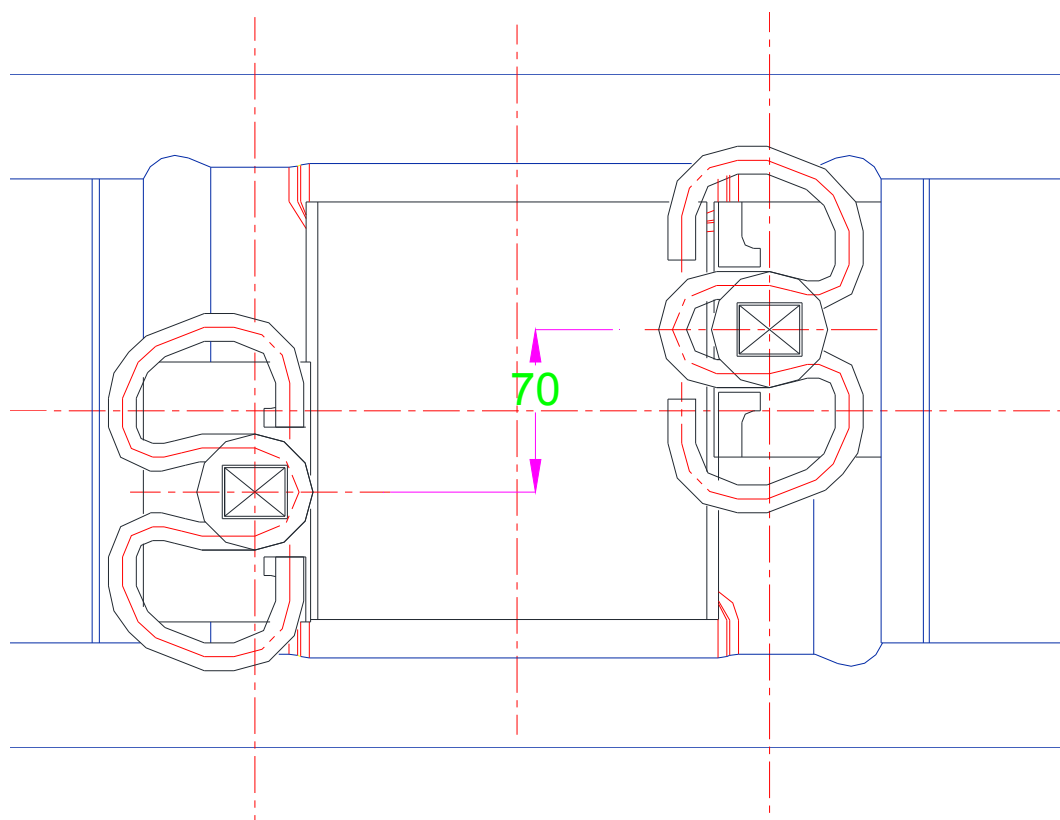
Posicionamento das fixações em travessas VAX LU 41 V
